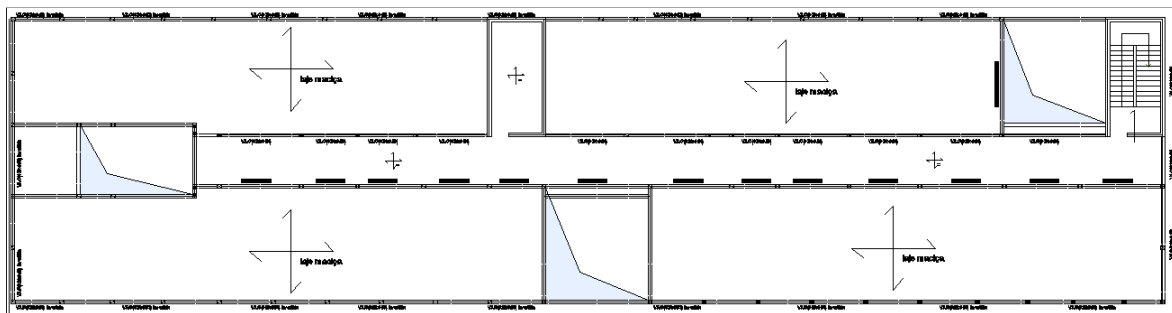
Planta estrutural da cobertura do módulo B (s/escala)
